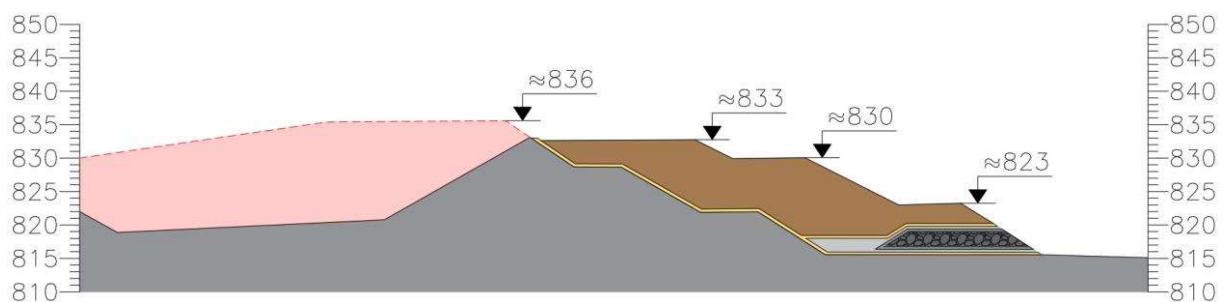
Seção Tipo da escavação do material a montante da Barragem B1
